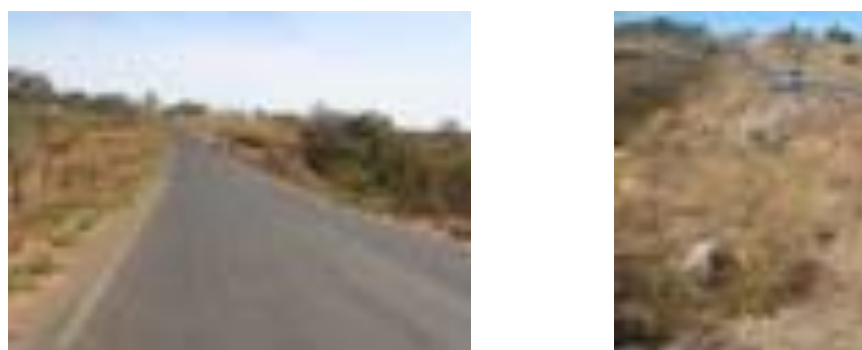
Detalhe do aterro onde foi realizado o ensaio.
